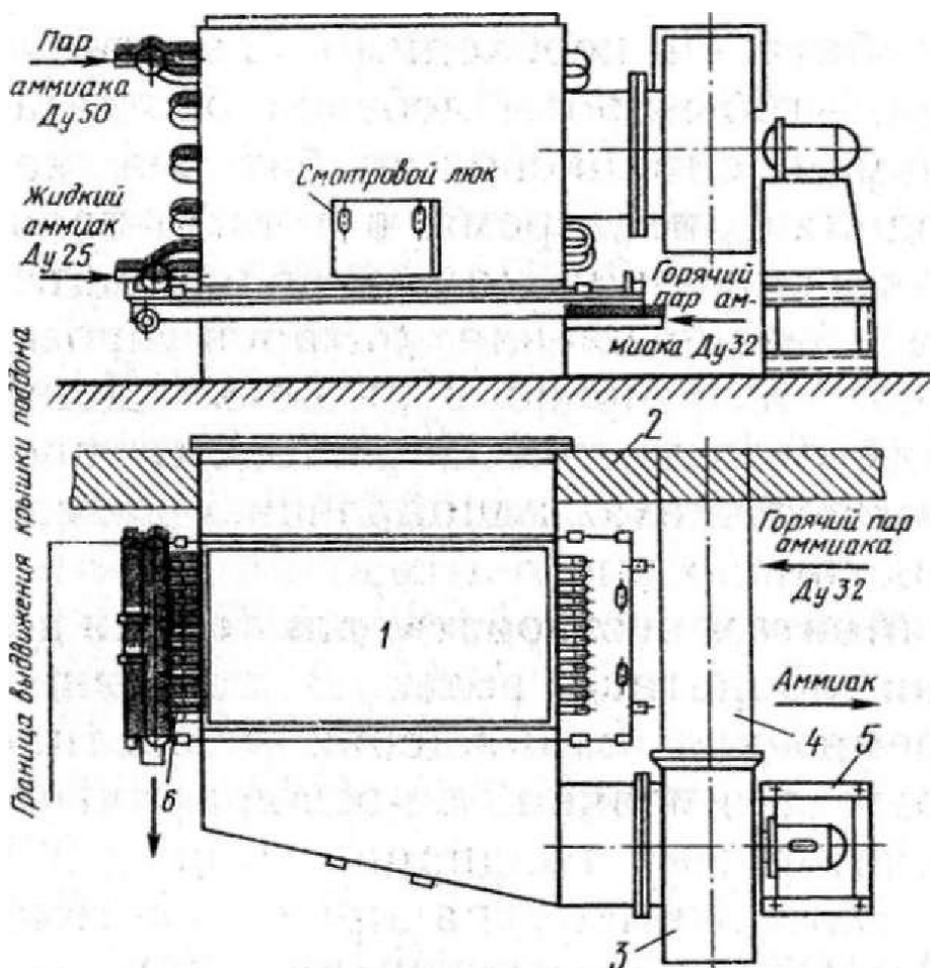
Схема монтажа напольного воздухоохладителя:
